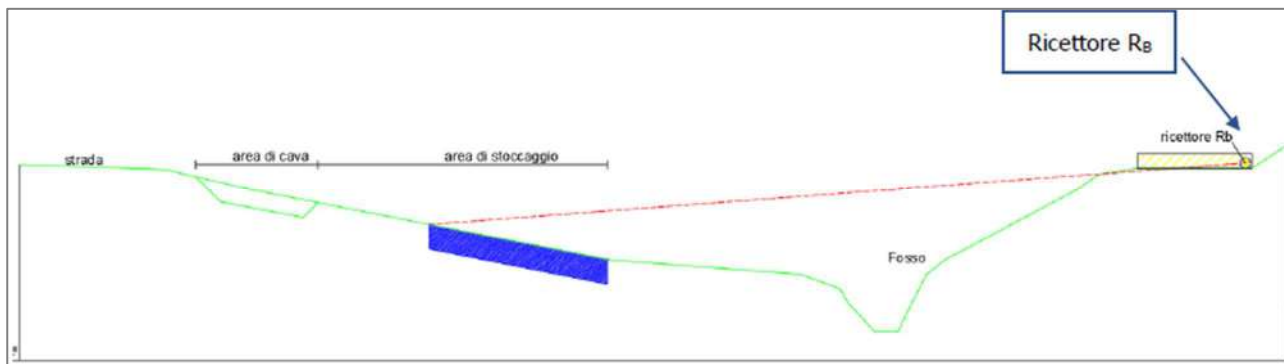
Sezione dell'area di cava rispetto al ricettore Rb.
